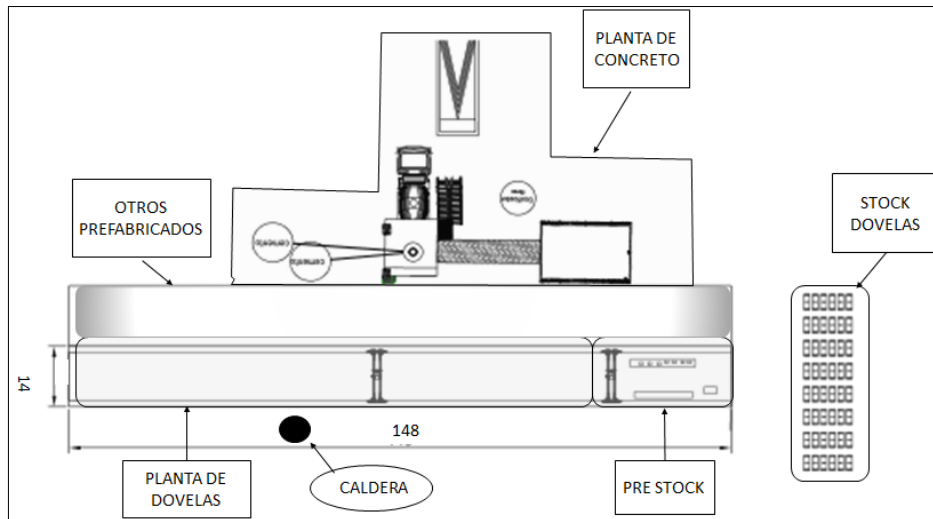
Layout de planta de fabricación de dovelas (Fuente: Layout de obra)
